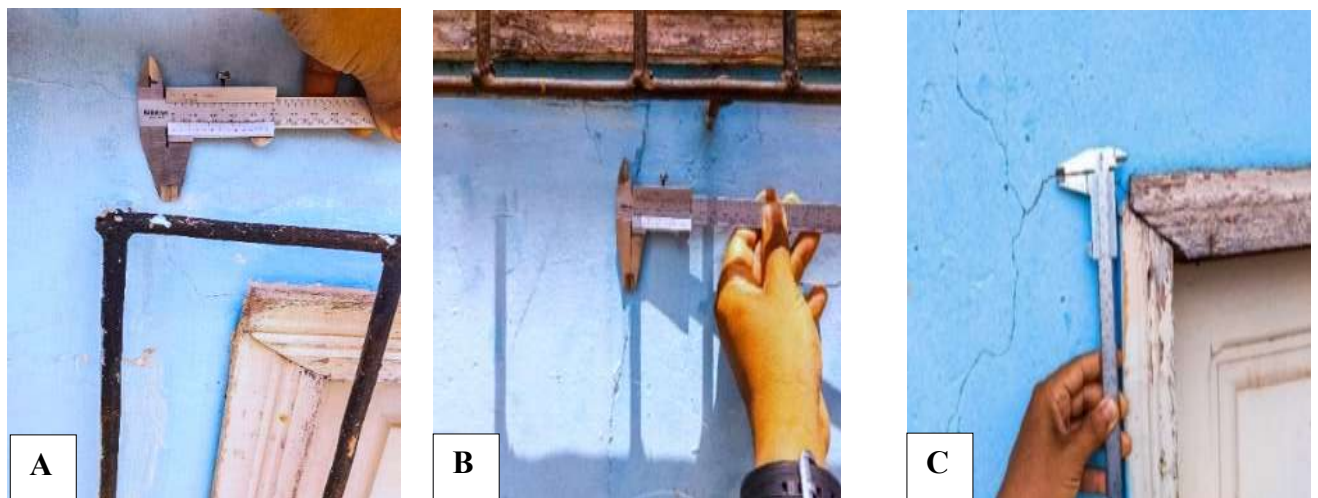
Presença de patologia: (A) fissuras inclinadas superior. (B) fissura vertical na parte inferior da janela. (C) trincas inclinadas na porta.
